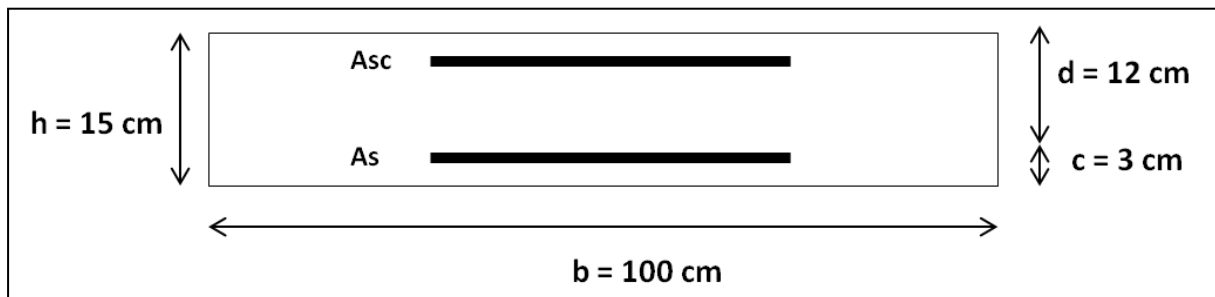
Dimensions de la section de la paillasse et du palier
